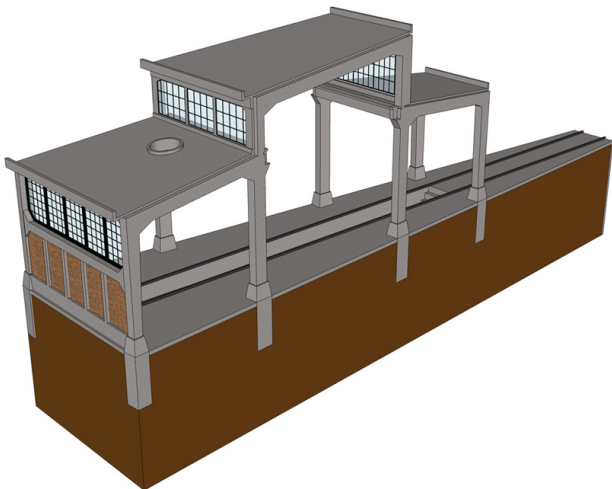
Elaboración propia a partir de planimetría original Casa de Máquinas de Temuco y medidas tomadas en terreno
